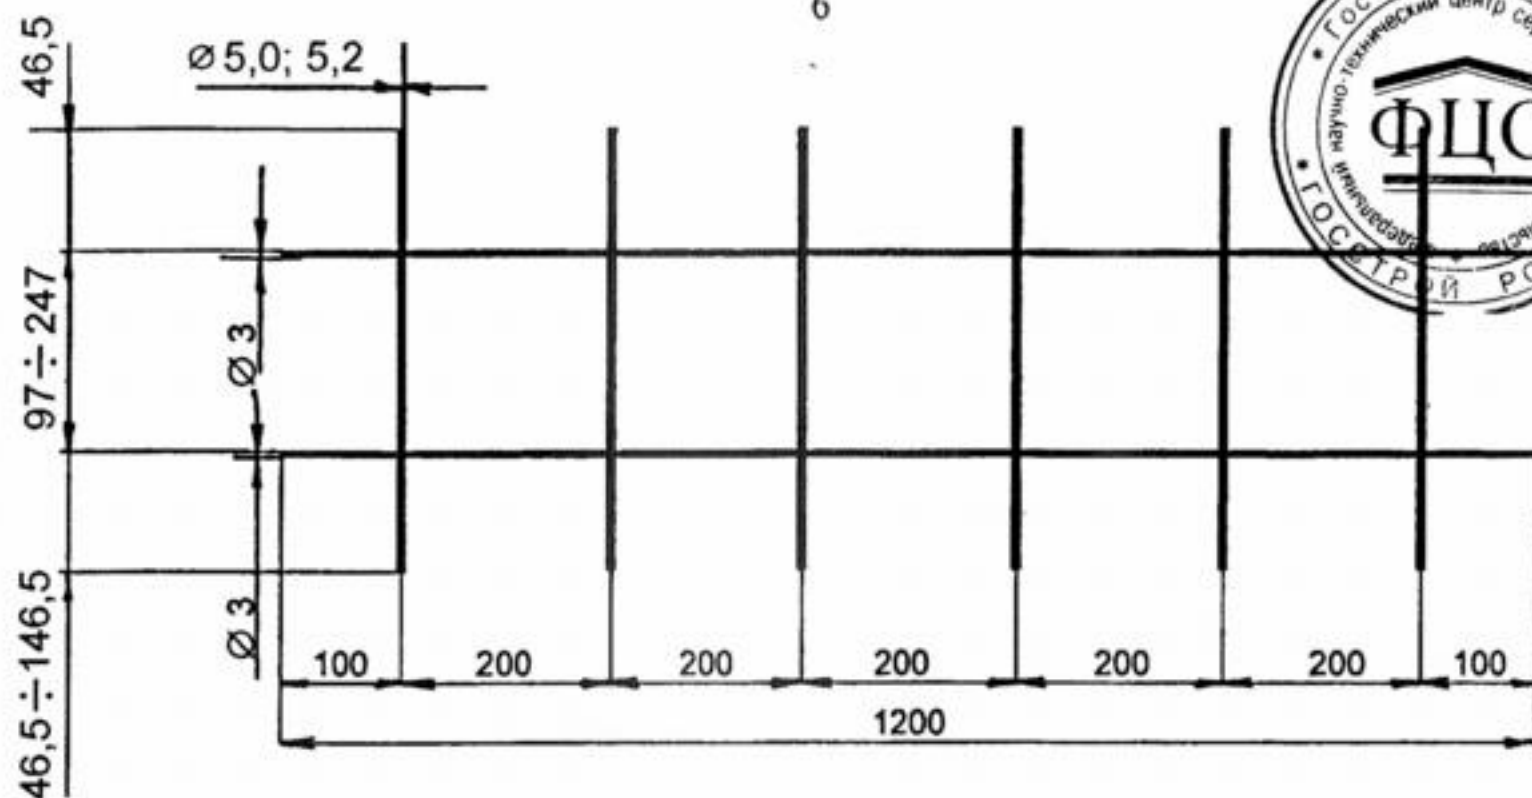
Рядовой элемент опалубочный наружной стены
